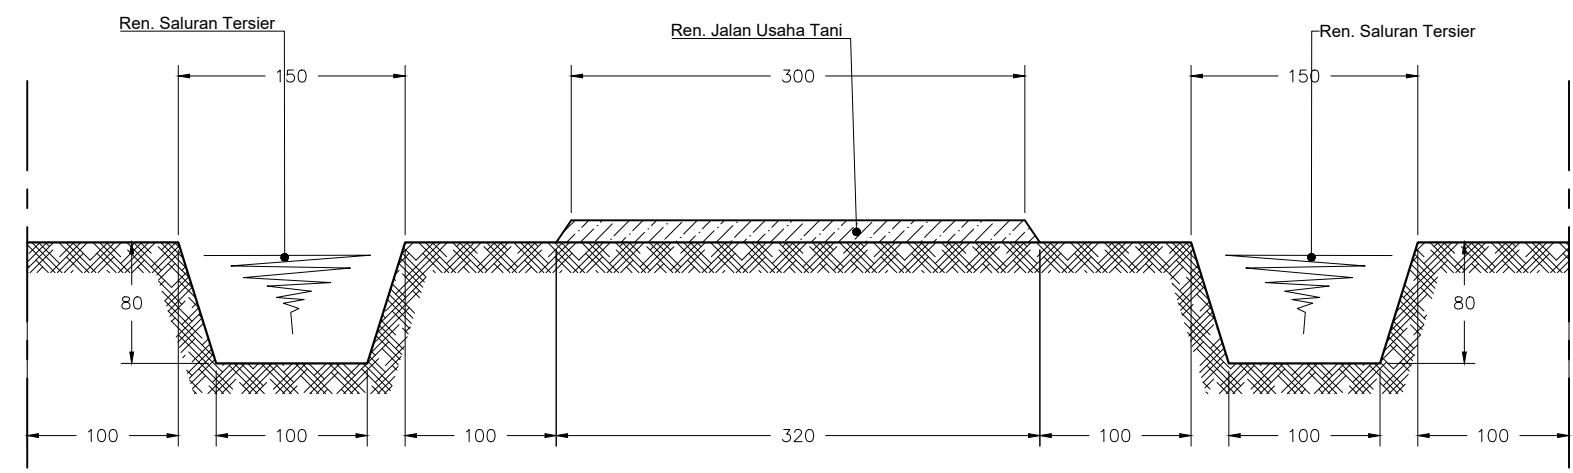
DETAIL SALURAN, TANGGUL DAN JALAN USAHA TANI (DETAIL 2)
